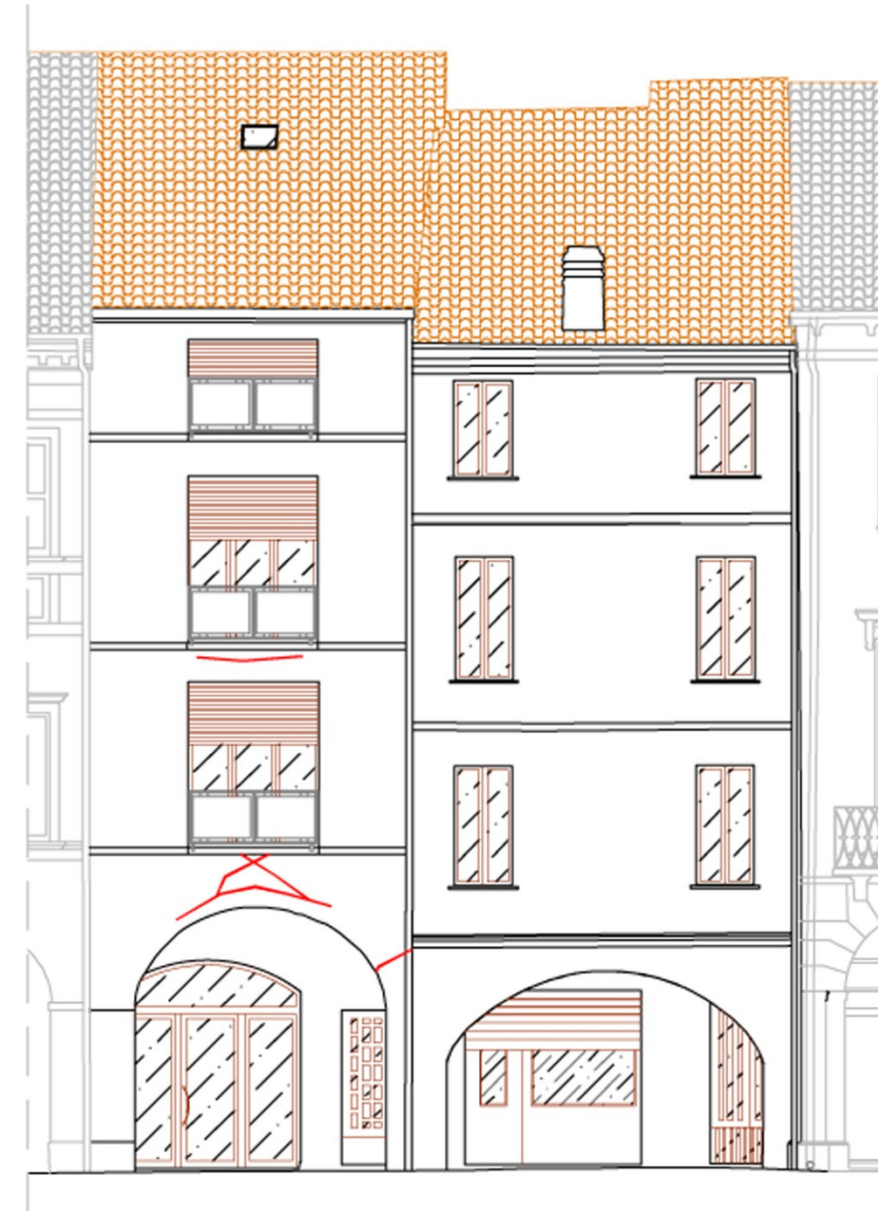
Prospetto su via G. Pico dell'edificio "D"
